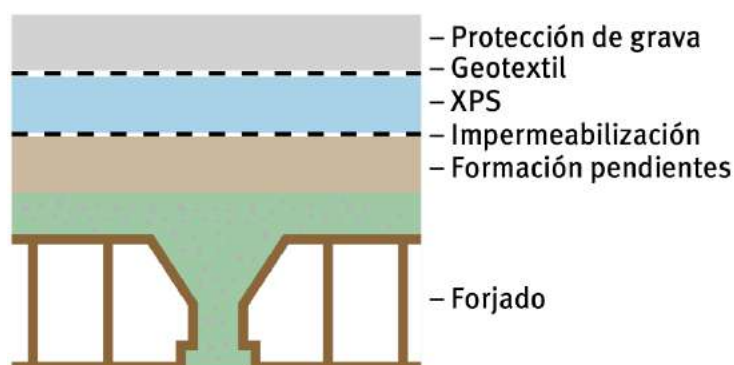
Esquema del sistema de aislamiento térmico de cubiertas no transitables
